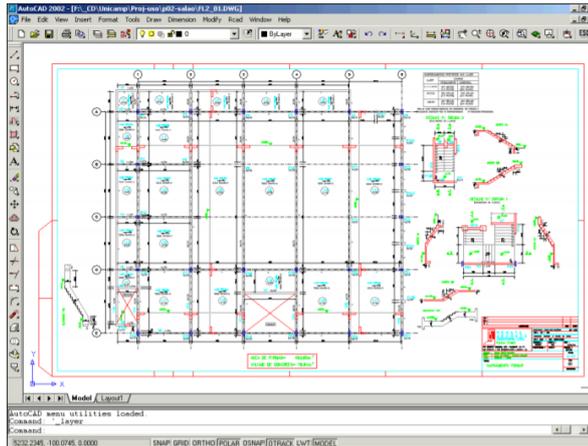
Visualização de um projeto estrutural elaborado no AutoCAD
